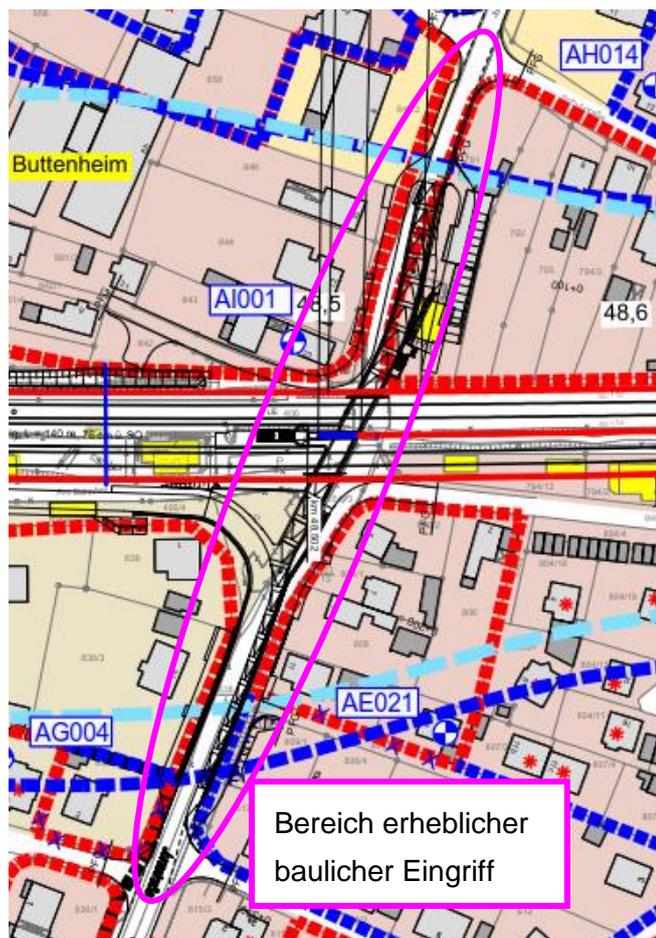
Übersichtslageplan zur EÜ Jurastraße in Altendorf
